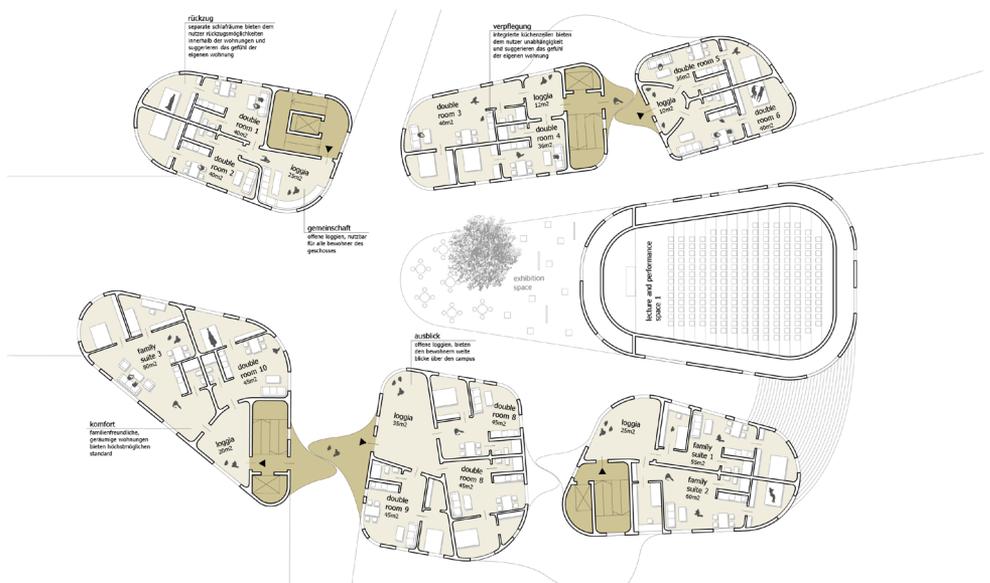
Grundriss 2. Obergeschoss
